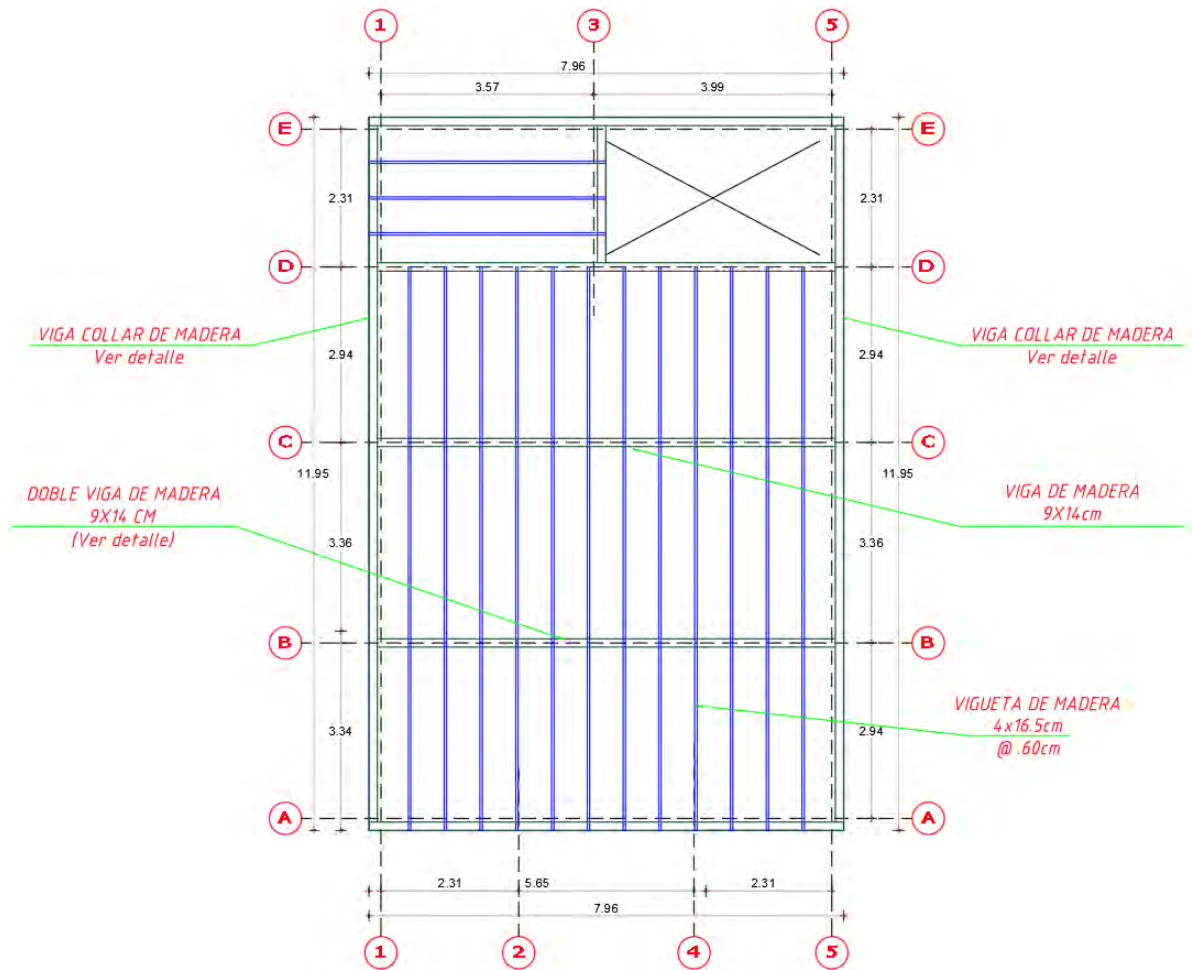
Plano de viguetas de techo en la edificación de Orcopampa
